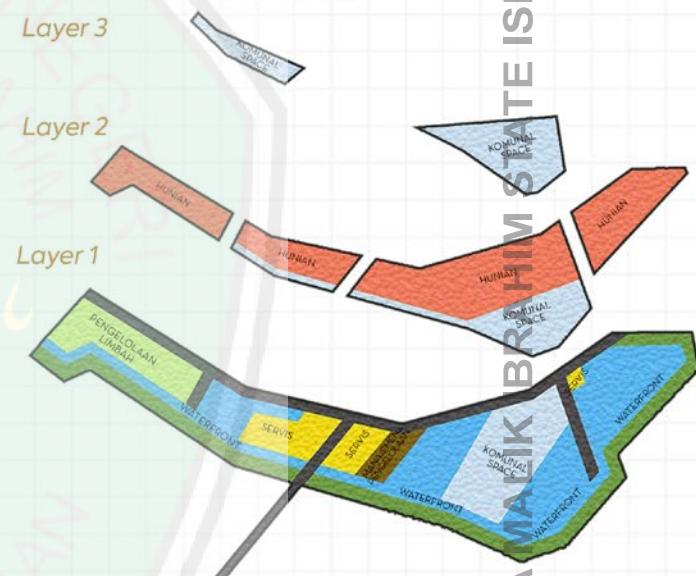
KeyPlan Area Pembangunan Pada Tapak
